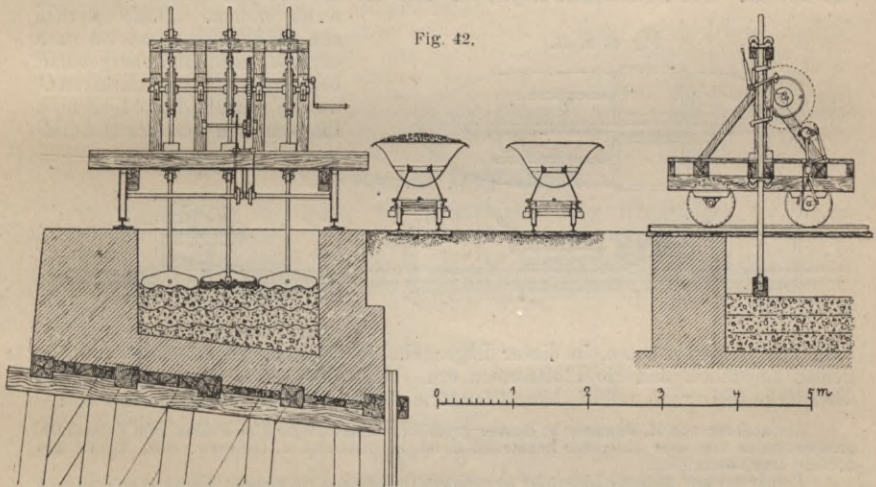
zeigt eine solche Anlage, welche Vering zum Stampfen des Betons in den Aussparungen der Kaimauern für die Hafenanlagen in Bremen verwendete und die sich gut bewährte. Sie besteht aus einem Gerüste, welches auf einem Gleise läuft. In dem Gerüste hängen 3 Stampfen mit wellenförmigen unteren Flächen neben einander, welche mittels eines durch 4 Mann zu bedienenden Windwerkes (versehen mit Hebelverbindungen, Mitnahmescheiben und Ausrückvorrichtungen) 0,30^m von der Betonoberfläche abgehoben werden und dann kurz hinter einander frei herabfallen. Das Fallgewicht dieser Stampfen betrug 60 bis 120^{kg} bei 0,2 bis 0,4^{qm} Grundfläche. Durch eine entsprechende Verbindung des Windwerkes mit einer Laufachse des Gerüsts wurde nach jedesmaligem Anheben und Fallen der drei Stampfen eine Vorwärtsbewegung des ganzen Gerüsts mittels Einrückens einer der beiden vorhandenen Sperrklinken (die eine für Vorwärts-, die andere für Rückwärtsbewegung) bewirkt, welche bei einer Breite der Stampfen von 40^{cm} etwa nur 35^{cm} betrug.
